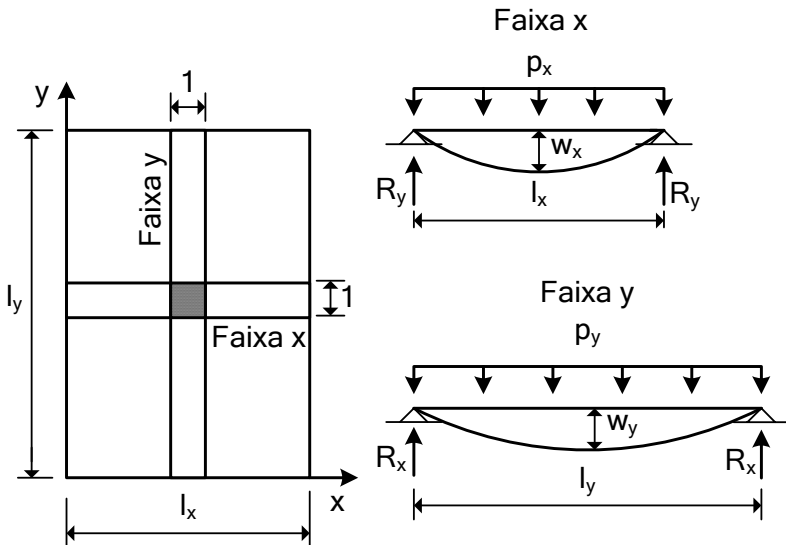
Laje simplesmente apoiada nos quatro lados
